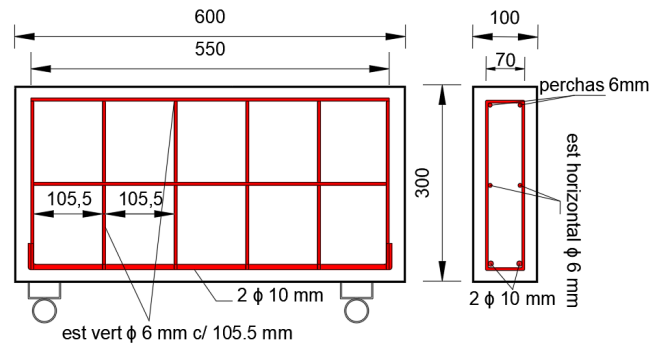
Dimensiones geométricas y detalle de armado de especímenes con armadura a corte mínima.
